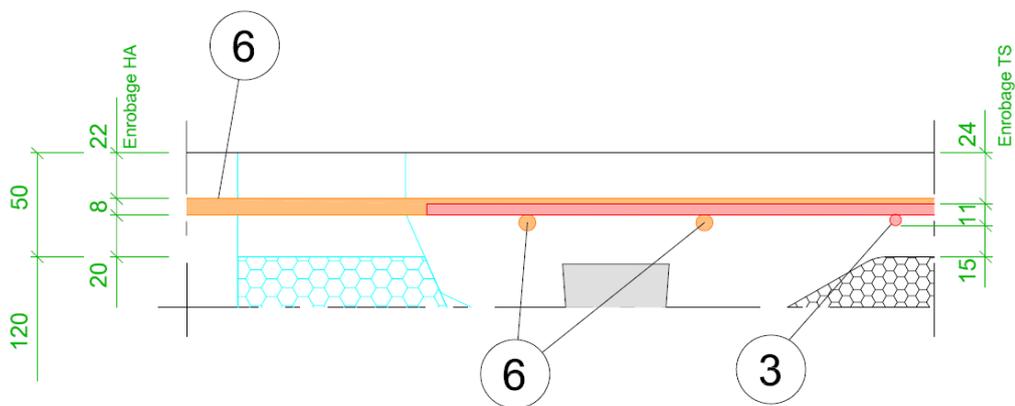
Vue de coupe – Ferrailage transversal (exemple)
